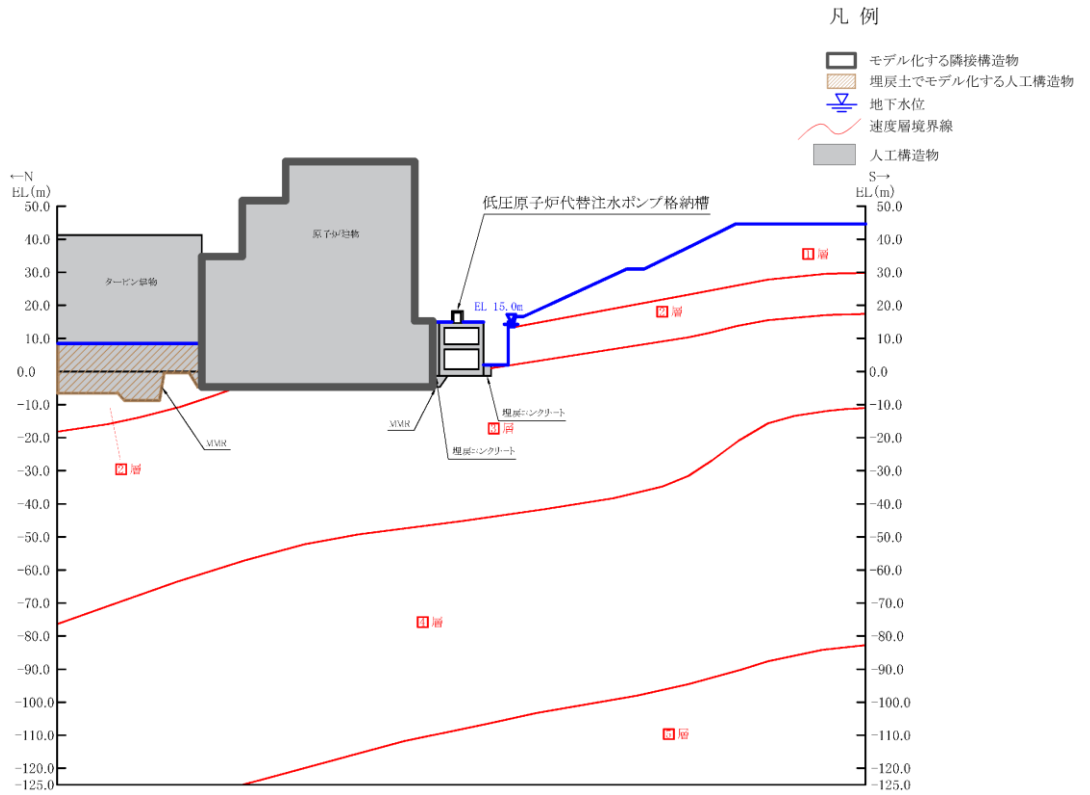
低圧原子炉代替注水ポンプ格納槽 評価対象断面図 (A-A 断面位置)
